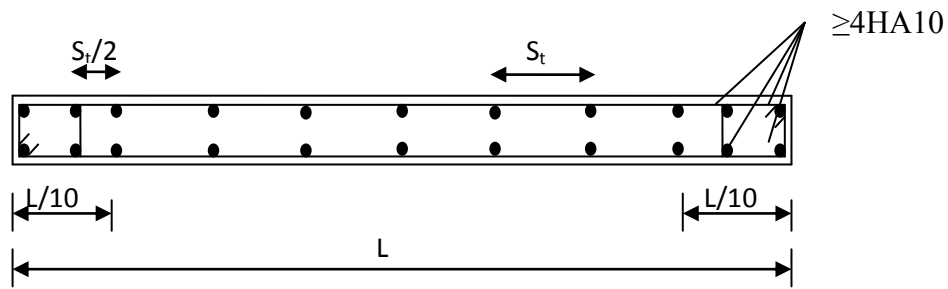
Disposition des armatures verticales dans les voiles.
